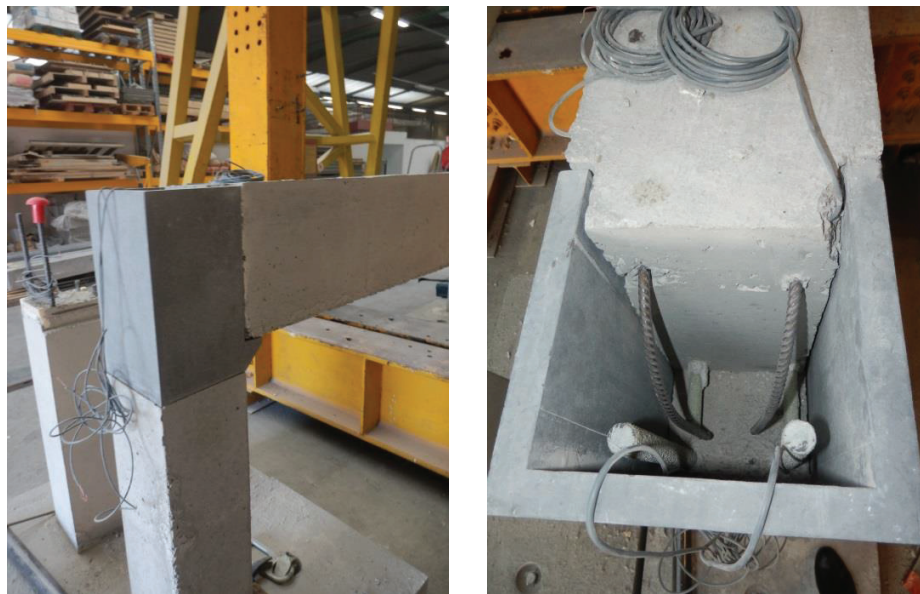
Positionnement de la poutre de portique dans le coffrage perdu servant de nœud
